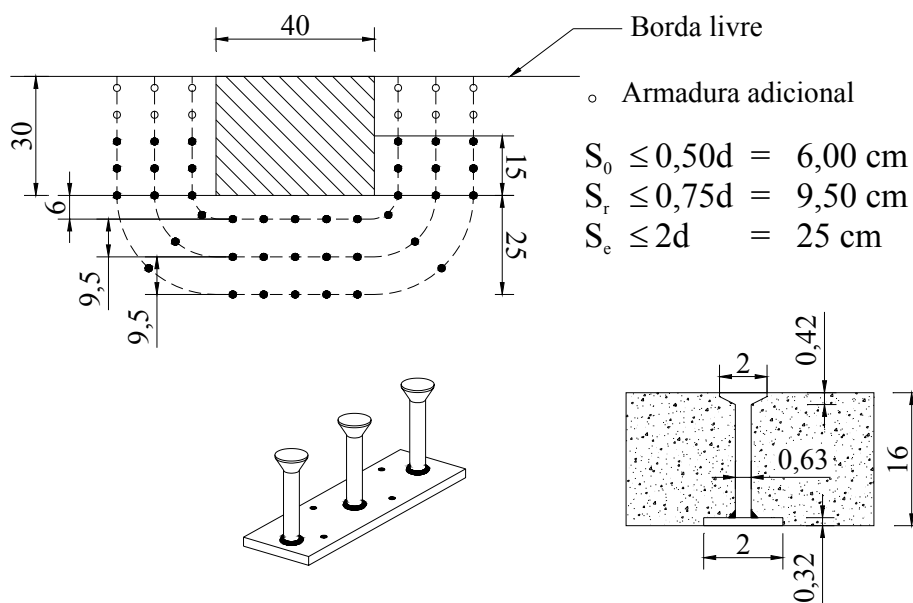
11 Arranjo da armadura de punção para o pilar P2
